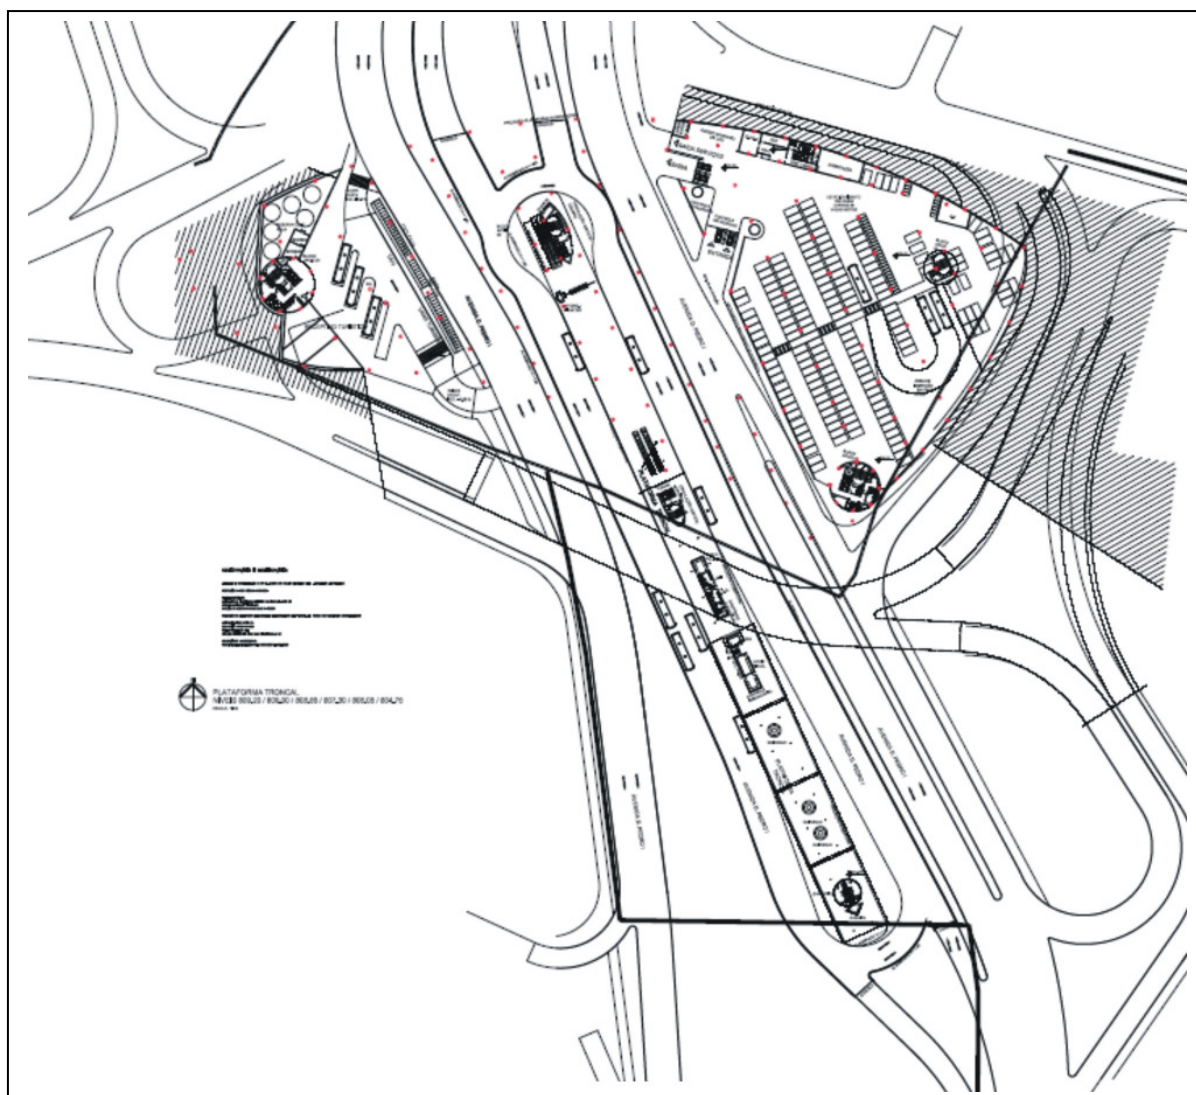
Planta de situação esquemática da Estação Pampulha
